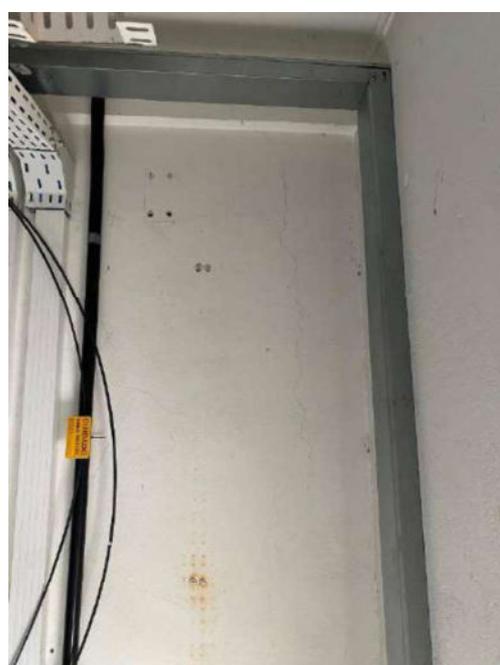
Detalhe - Presença de fissuras na alvenaria
